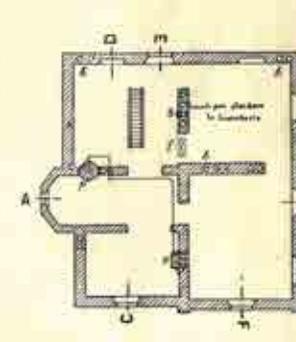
Pianta del sottotetto (Scala 1:200)
